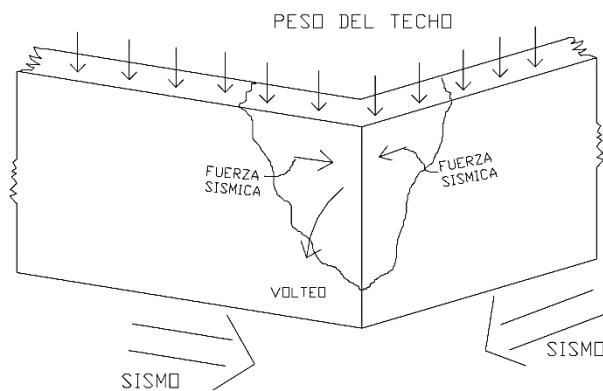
Grietas en las esquinas y desplome parcial. *Fuente: Torrealva, 2003
